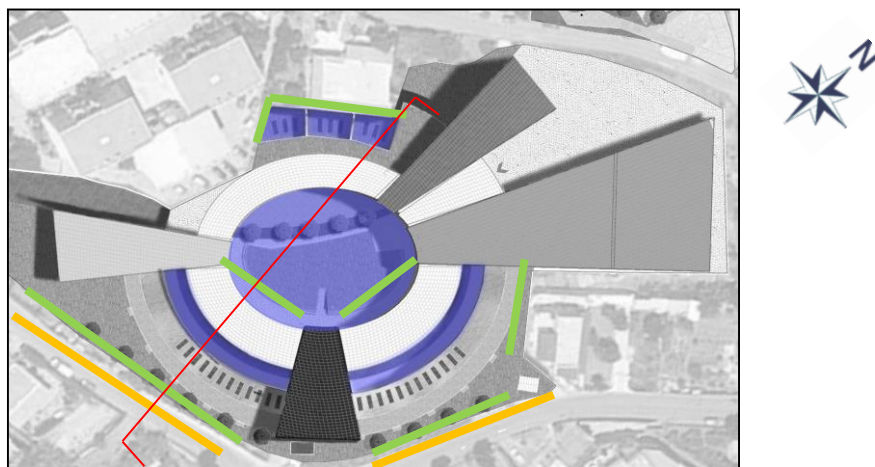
Posizione delle barriere verdi (Verde) e delle barriere continue (Arancione)
